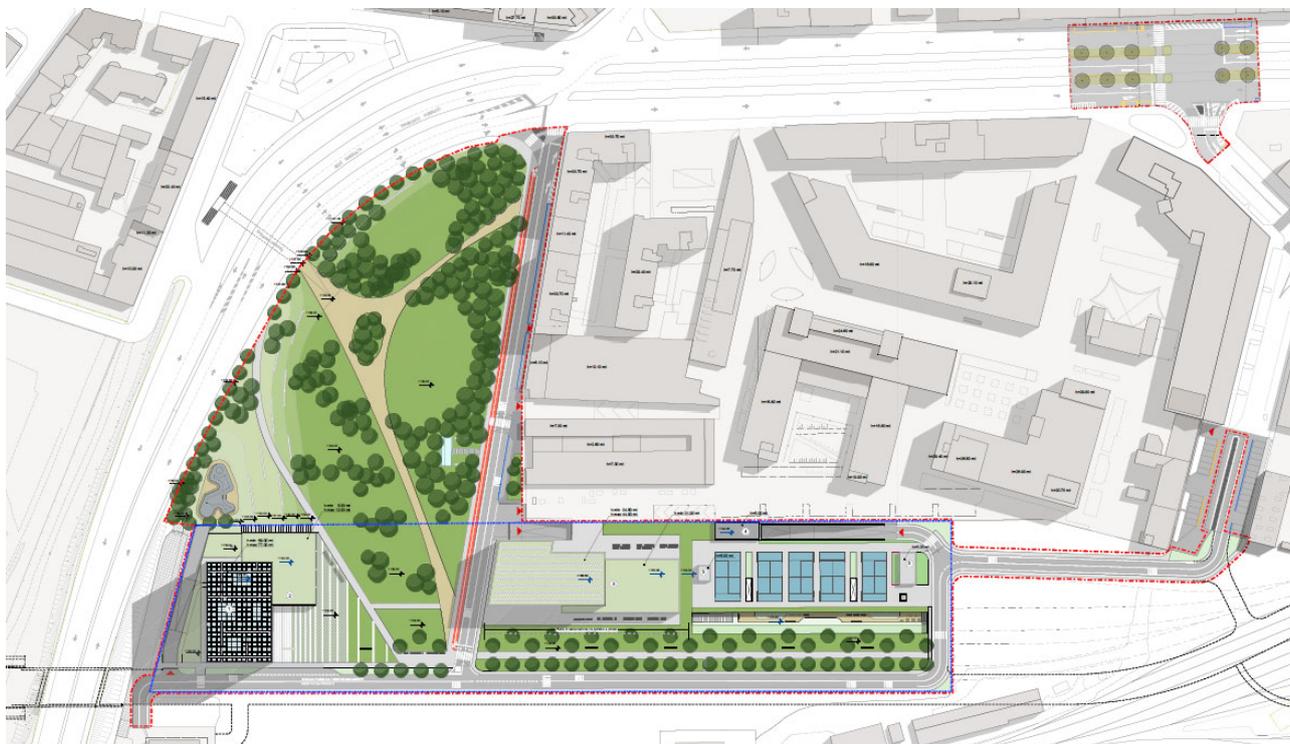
Nuovo assetto dell'area – planimetria di progetto
